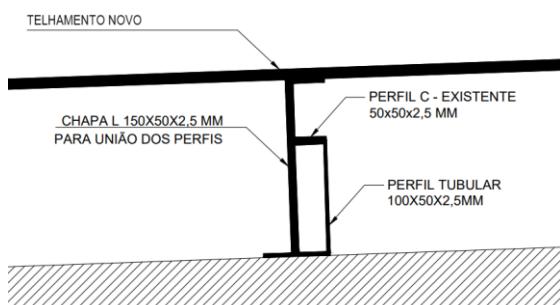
Detalhamento da adequação da estrutura metálica.
